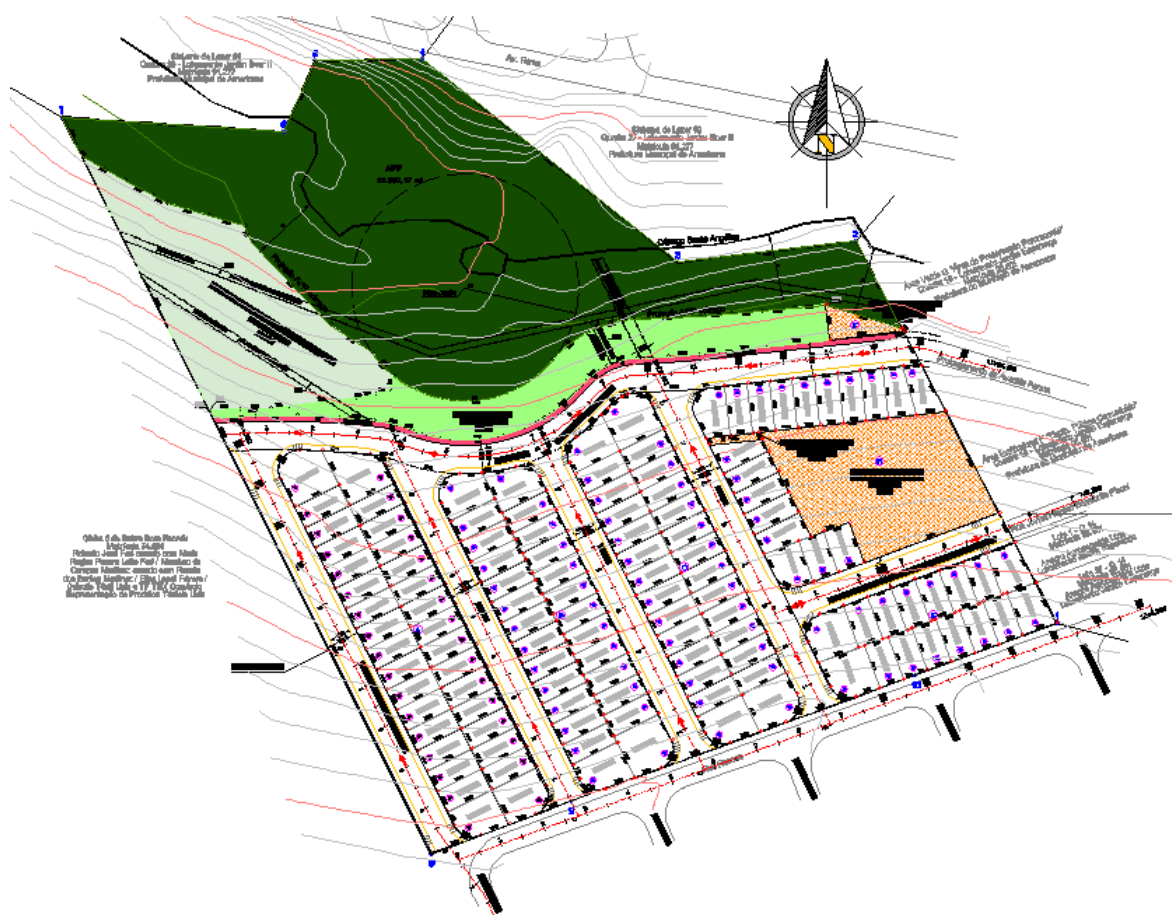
Sistema Viário – Ruas e avenida que serão pavimentadas
